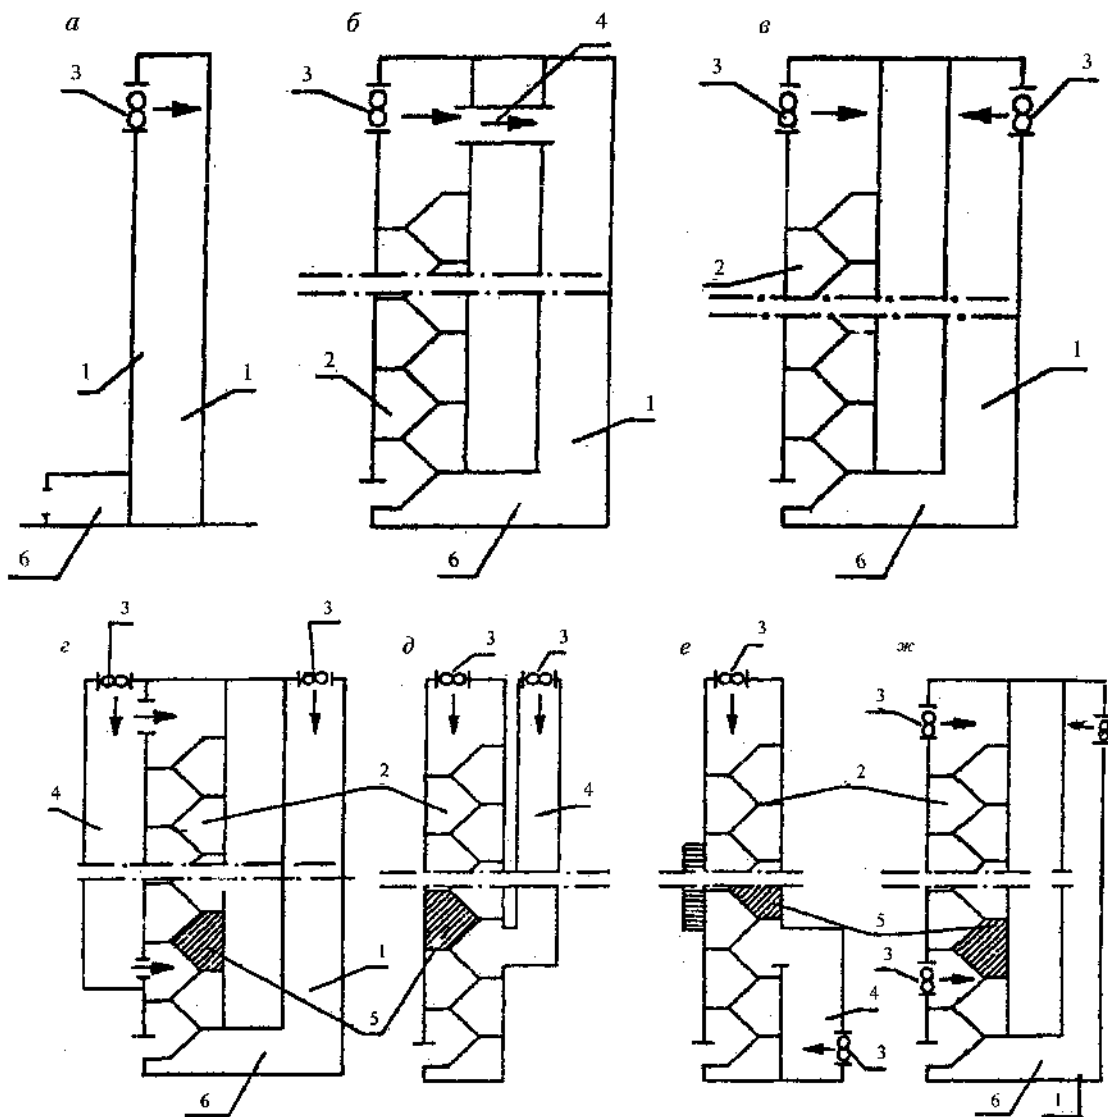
Принципові схеми подачі зовнішнього повітря до незадимпованих сходових кліток 2-го типу та ліфтові шахти
